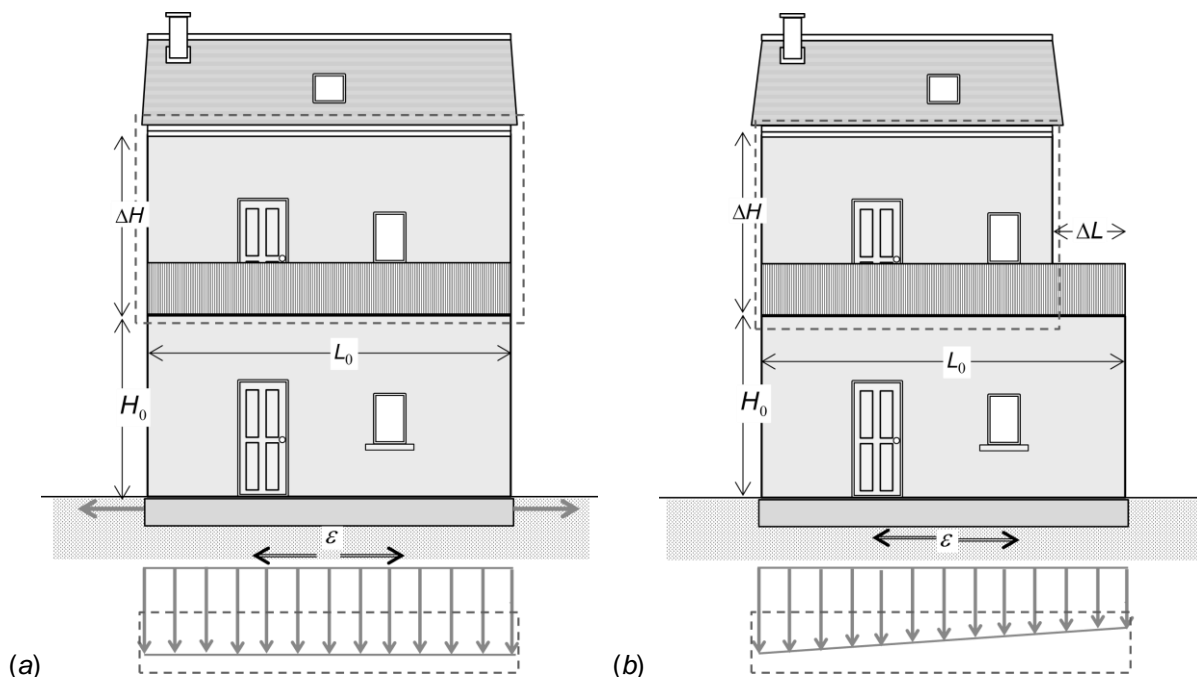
exemple de la surélévation (a) entière et (b) partielle d'un niveau
